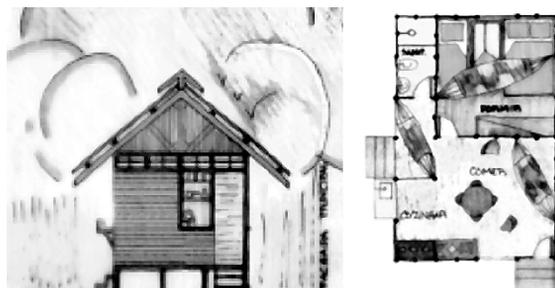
Madeira serrada para área rural – fachada e planta baixa
